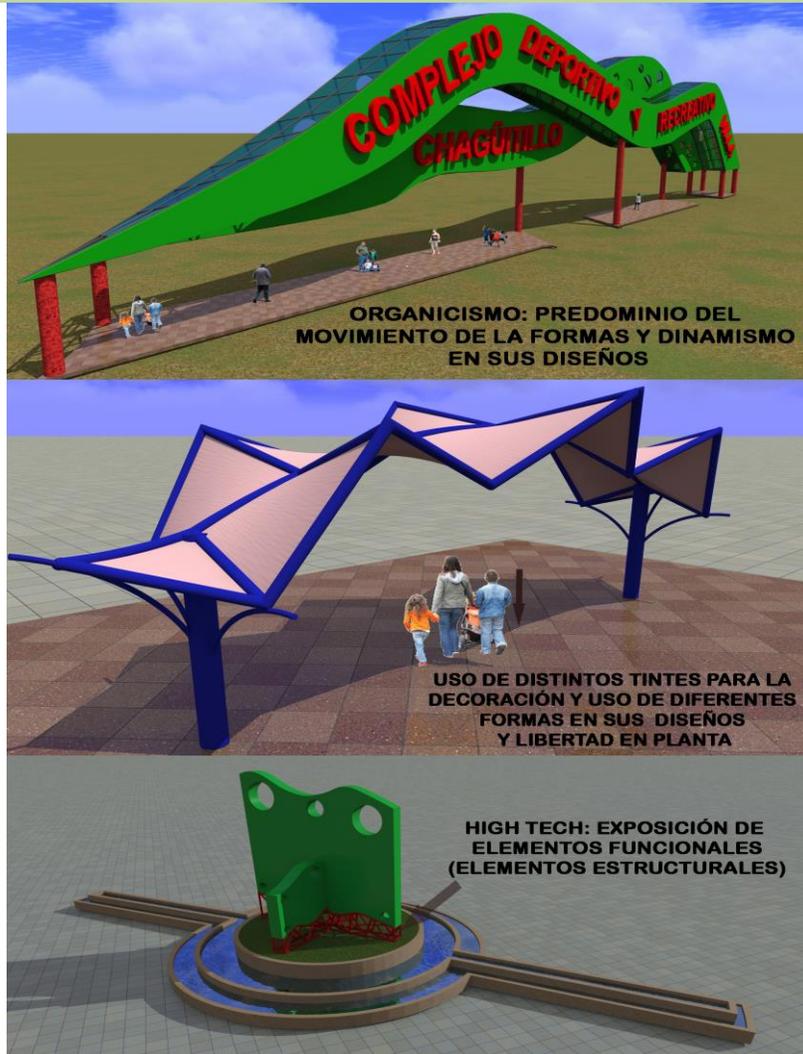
Tendencia estilística - Elementos arquitectónicos - Fuente: Elaboración propia
